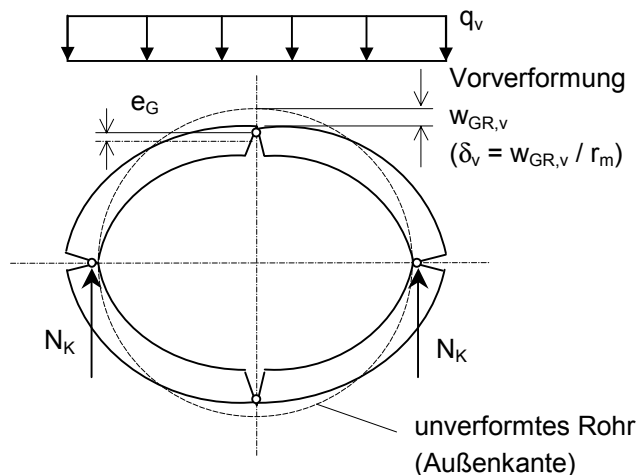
Viereckring, Druckkräfte N_K in den Kämpferlinien, vertikales Gleichgewicht
